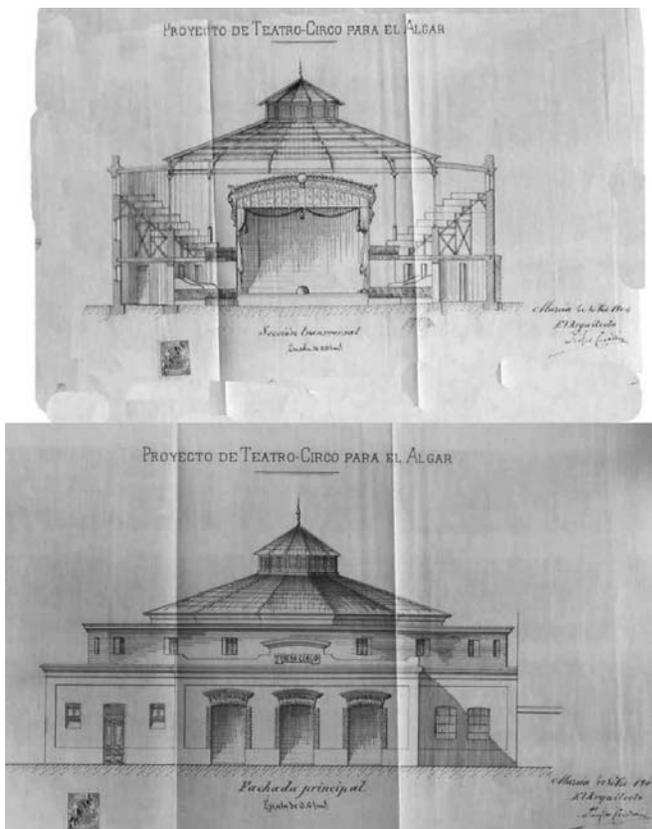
Planos originales de alzado principal y secciones del proyecto redactado por el Arquitecto Pedro Cerdán, para la construcción del Teatro Circo de El Algar.
